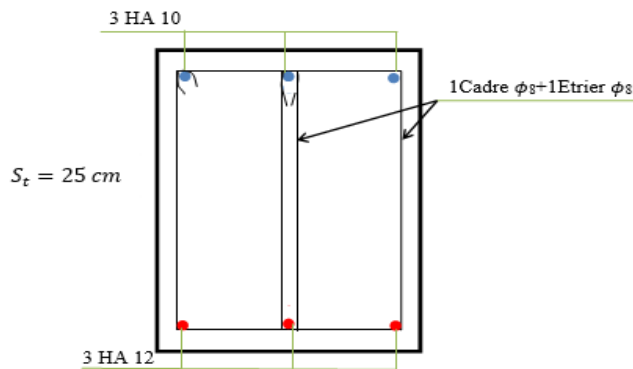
Schéma de ferrailages de la poutre de chaînage
